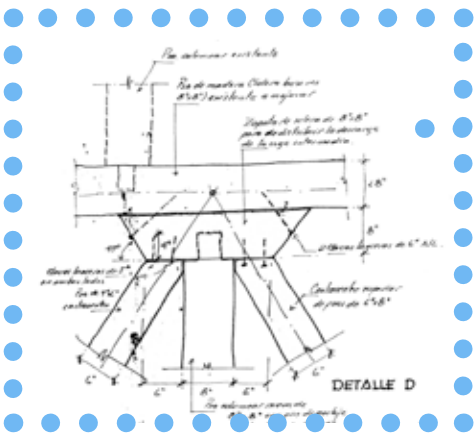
Structure primaire du taquezal : détail d'assemblage poteaux - poutres - contreventements (Source : Arch. Daisy Membréño)
